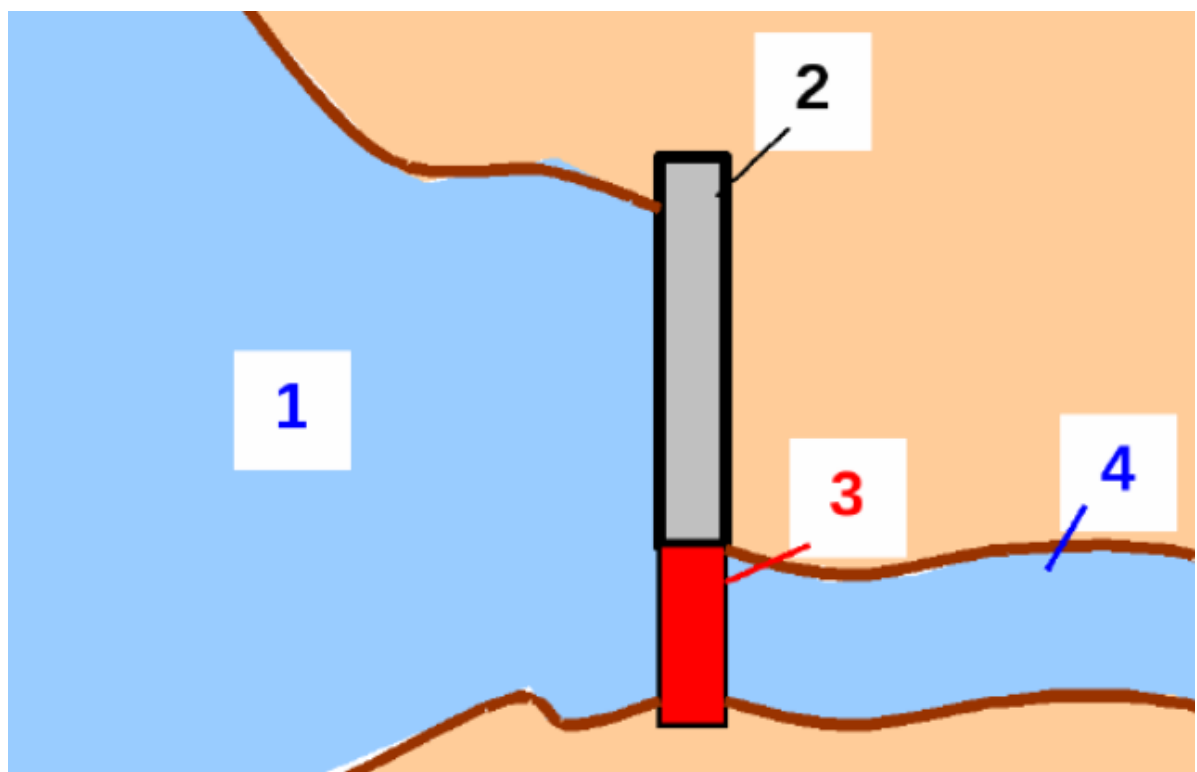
Рислова ГЕС на гірській річці: 1 - водосховище, 2 - земляна гребля, 3 - бетонна гребля разом з будівлею ГЕС, 4 – водоскид [1]
